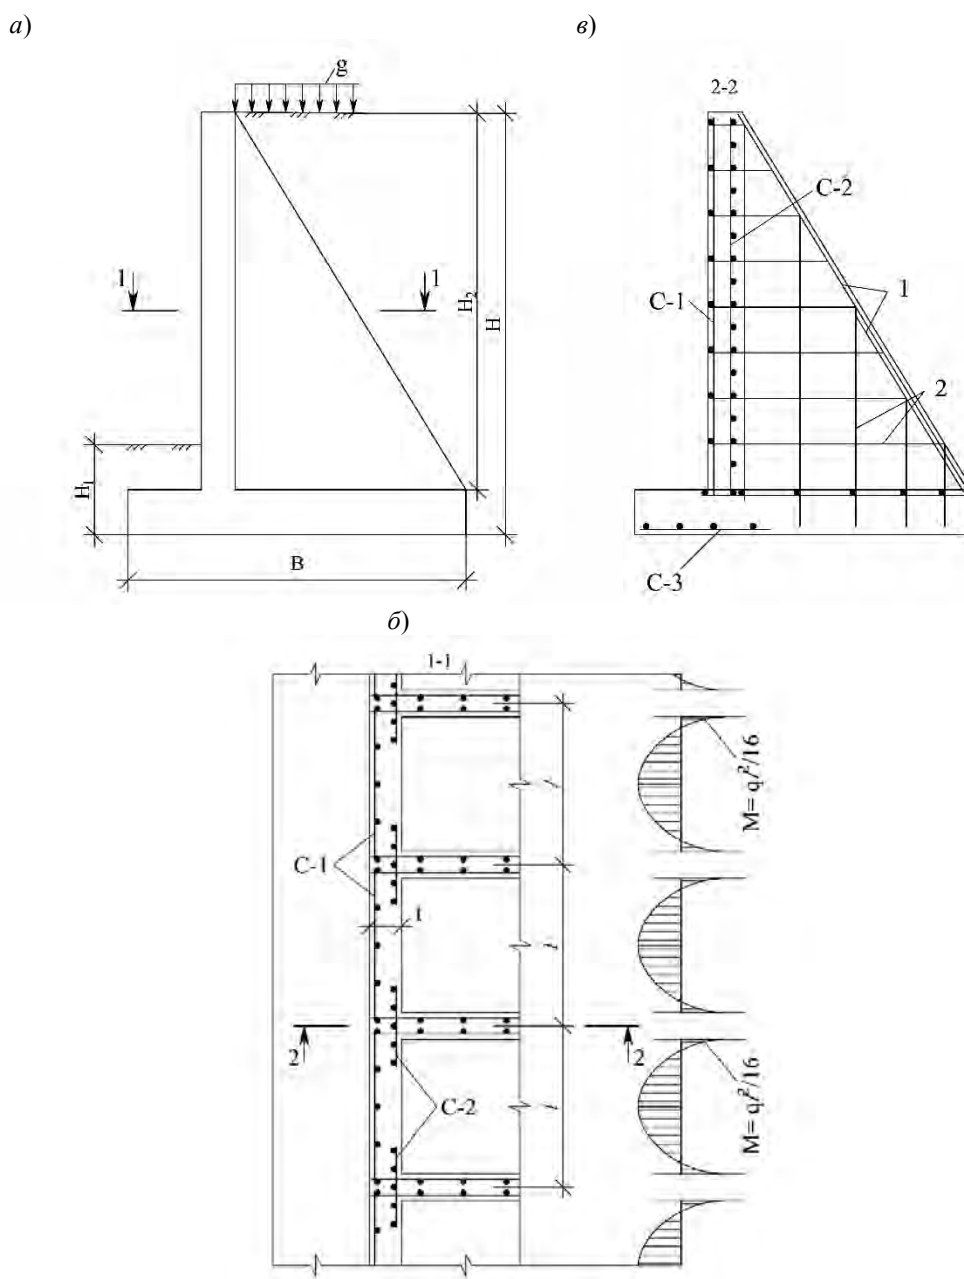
Схема армирования контрфорсной стены: а – общий вид; б – армирование лицевой плиты; в – армирование ребра; 1 – продольная рабочая арматура ребра; 2 – горизонтальные и вертикальные стержни
